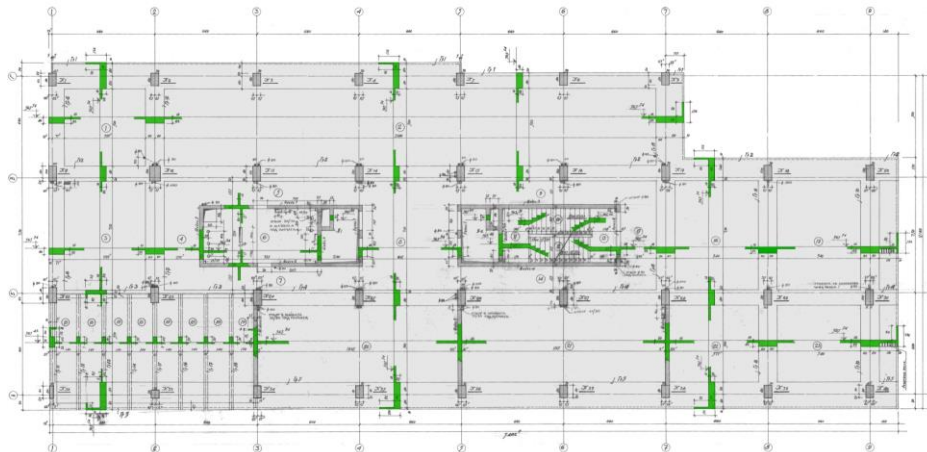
Изпълнение на стоманобетонната конструкция – блок 2 на УАСГ
